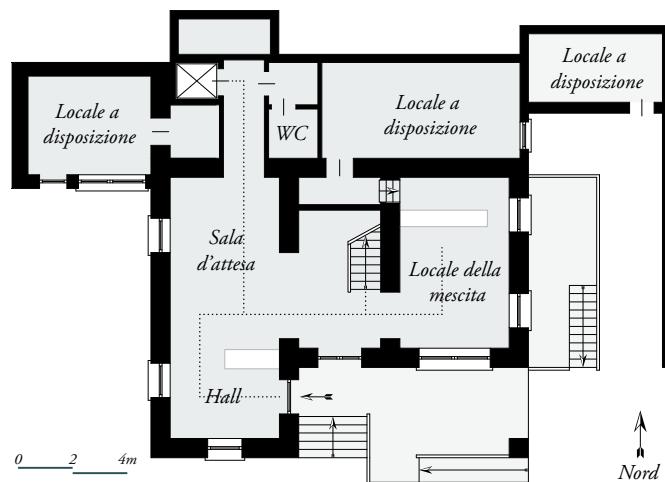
Palazzina delle Fonti, planimetria di progetto piano terreno (fuori scala).
